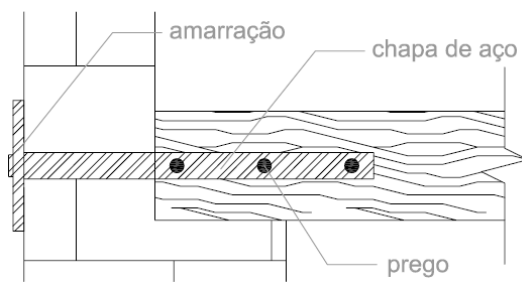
Viga apoiada na parede com fixação através de chapas metálicas amarradas à parede.
